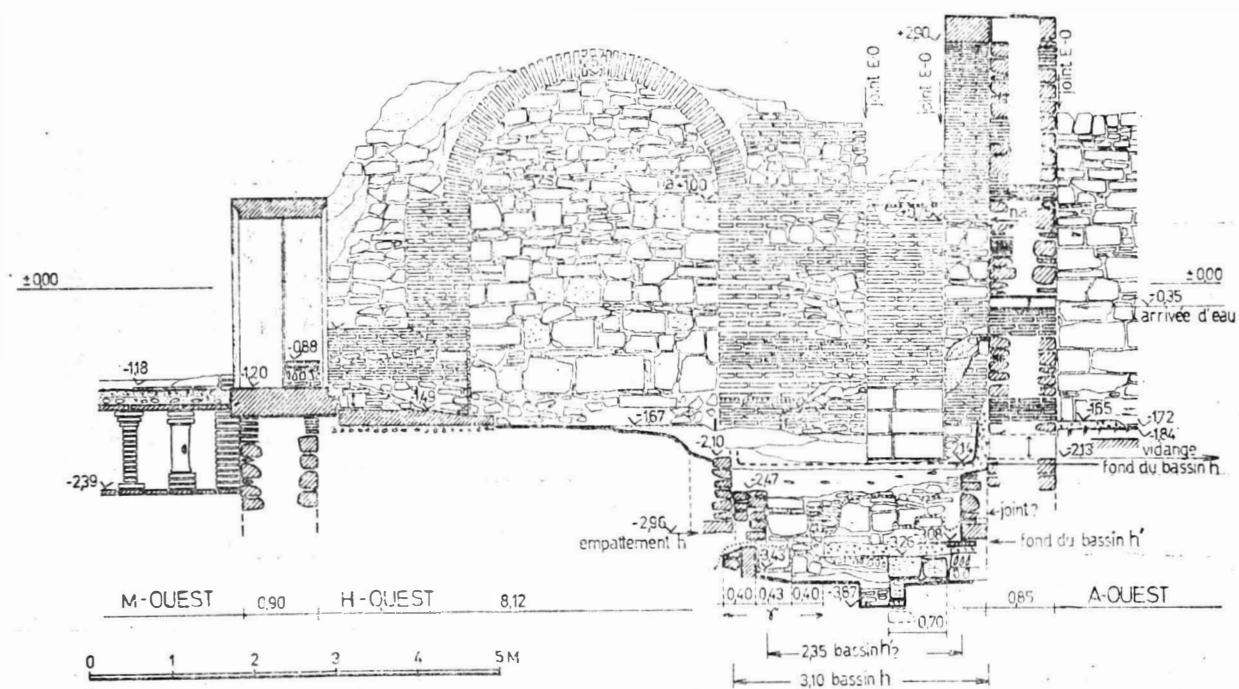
Thermes I. Elévation du mur ouest de la pièce H.
